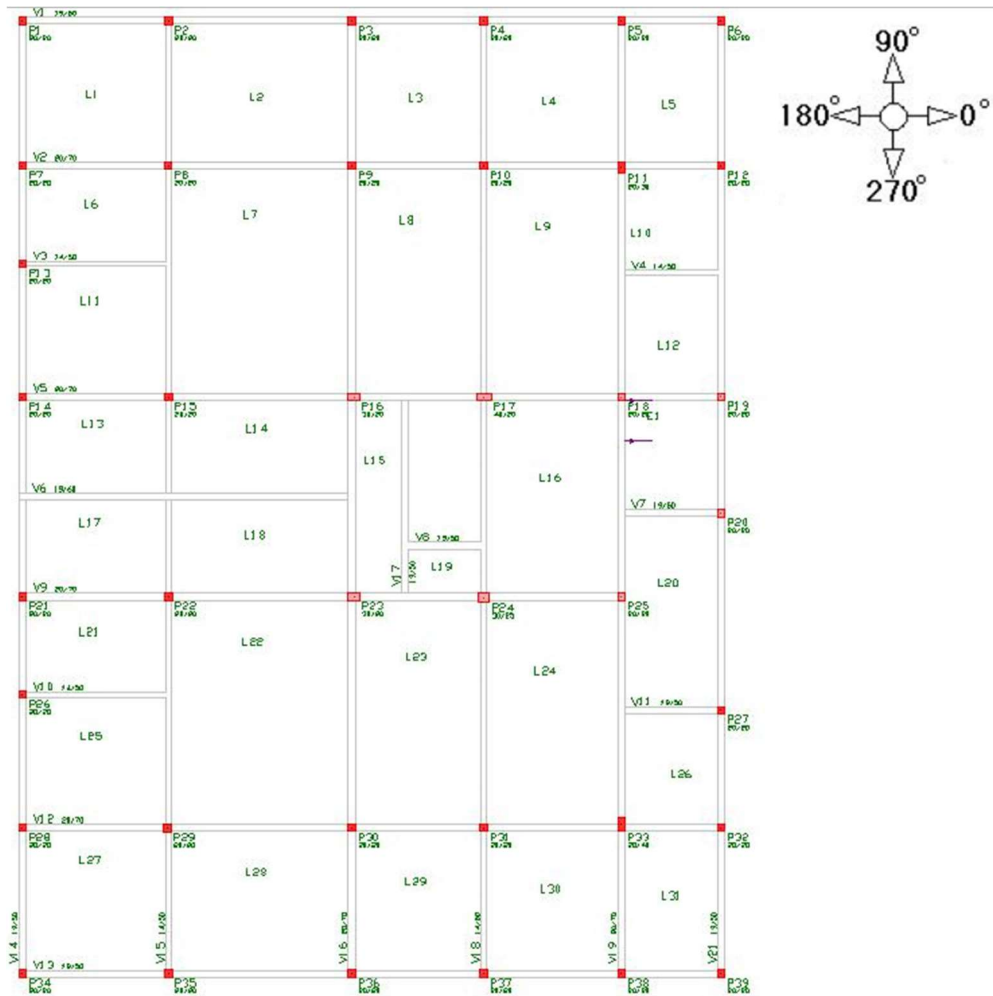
Vista superior dos elementos estruturais da cobertura do modelo II.
